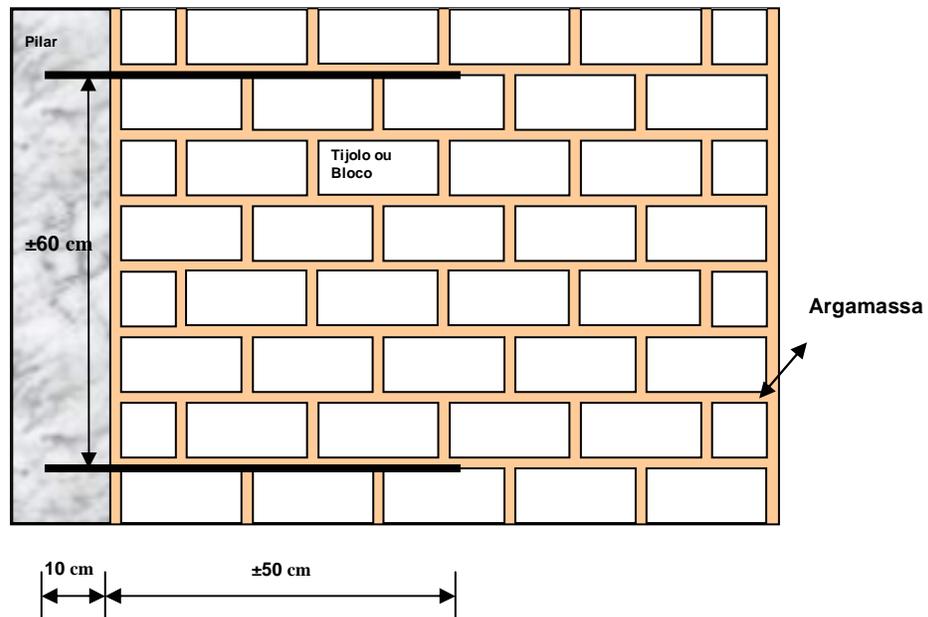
Esquema da ligação alvenaria com pilar de concreto armado (NBR 8545:1984).
